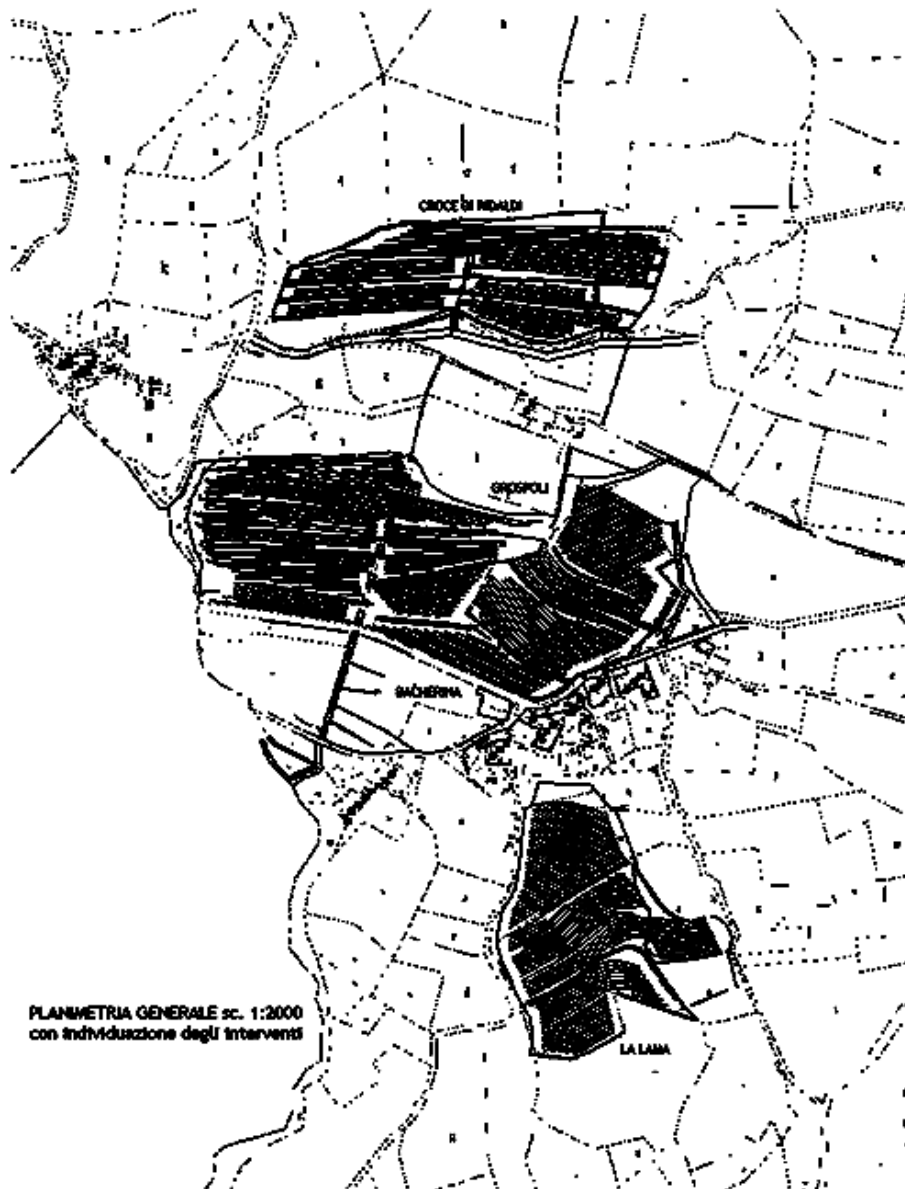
Planimetria generale dell'area individuata per gli interventi di restauro.
